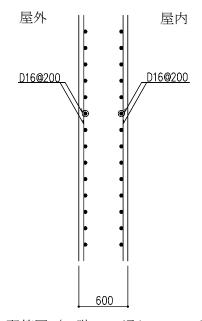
耐震壁の配筋図 (1階, YM通り X1~X2 通り間) (単位:mm)
